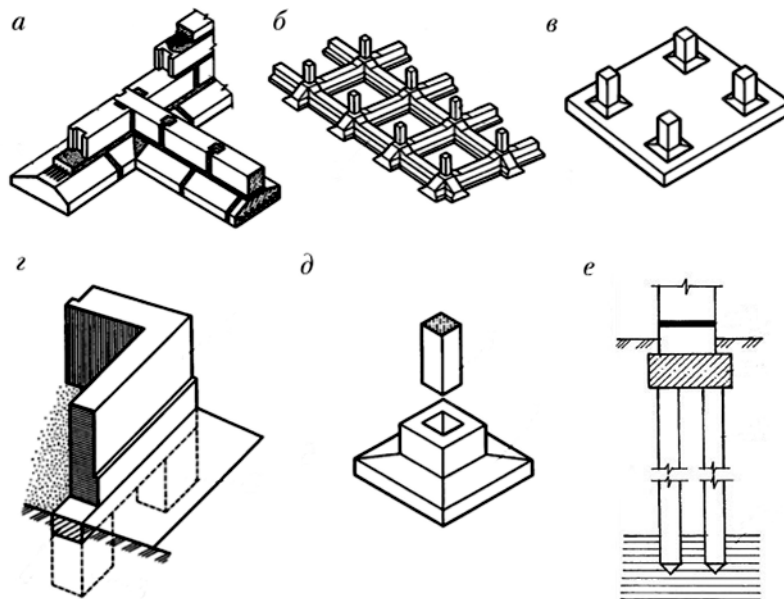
Виды фундаментов: а – ленточный под стены; б – ленточный под колонны; в – сплошной под колонны; г – столбчатый под стены; д – отдельный под колонну; е – свайный
